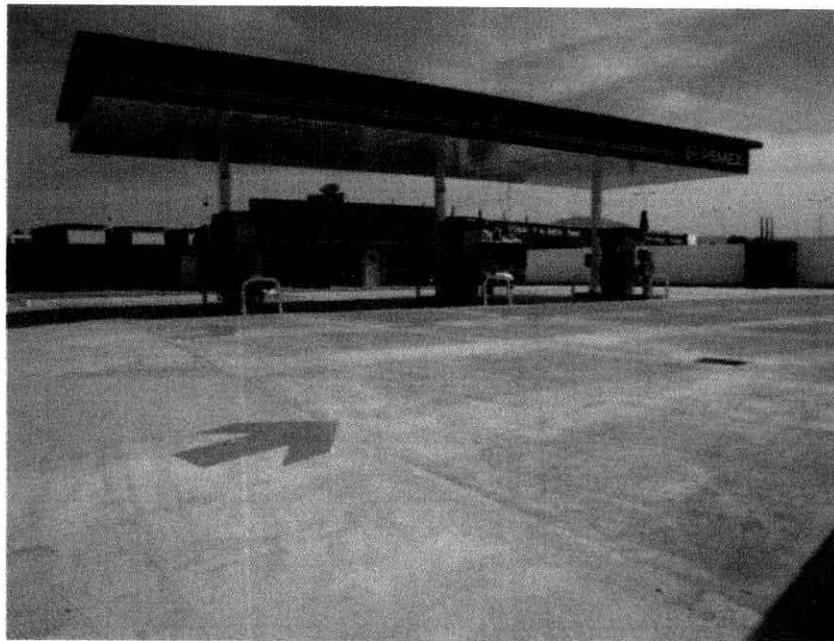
Vista de la Estación de Servicio.
